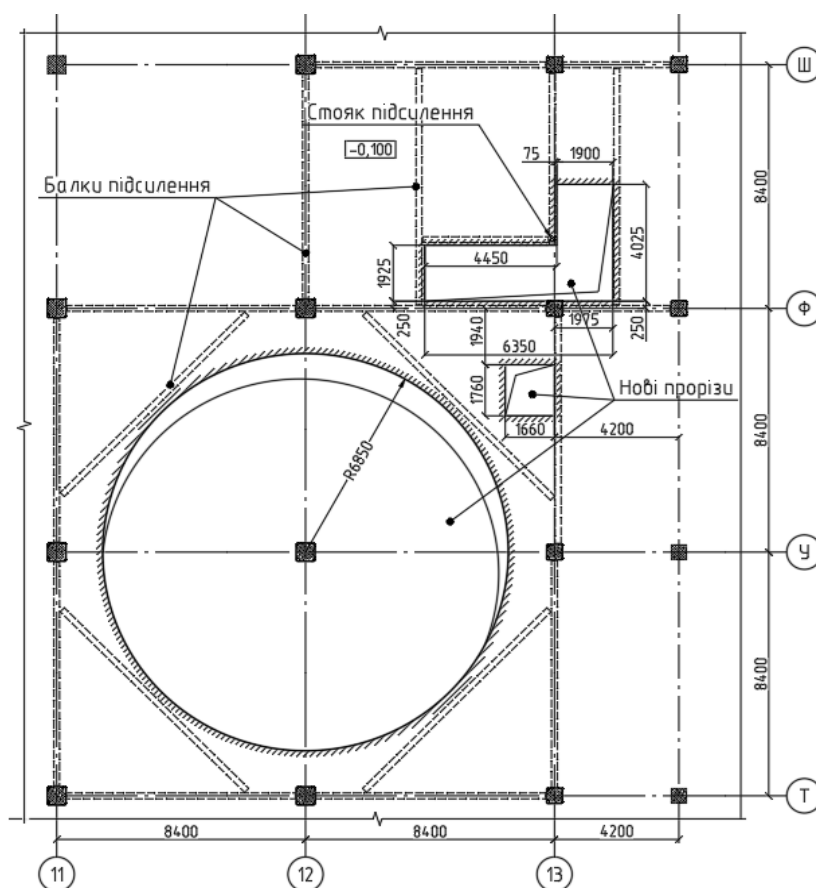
Фрагмент конструктивного плану з новими прорізами у перекритті і балками підсилення
